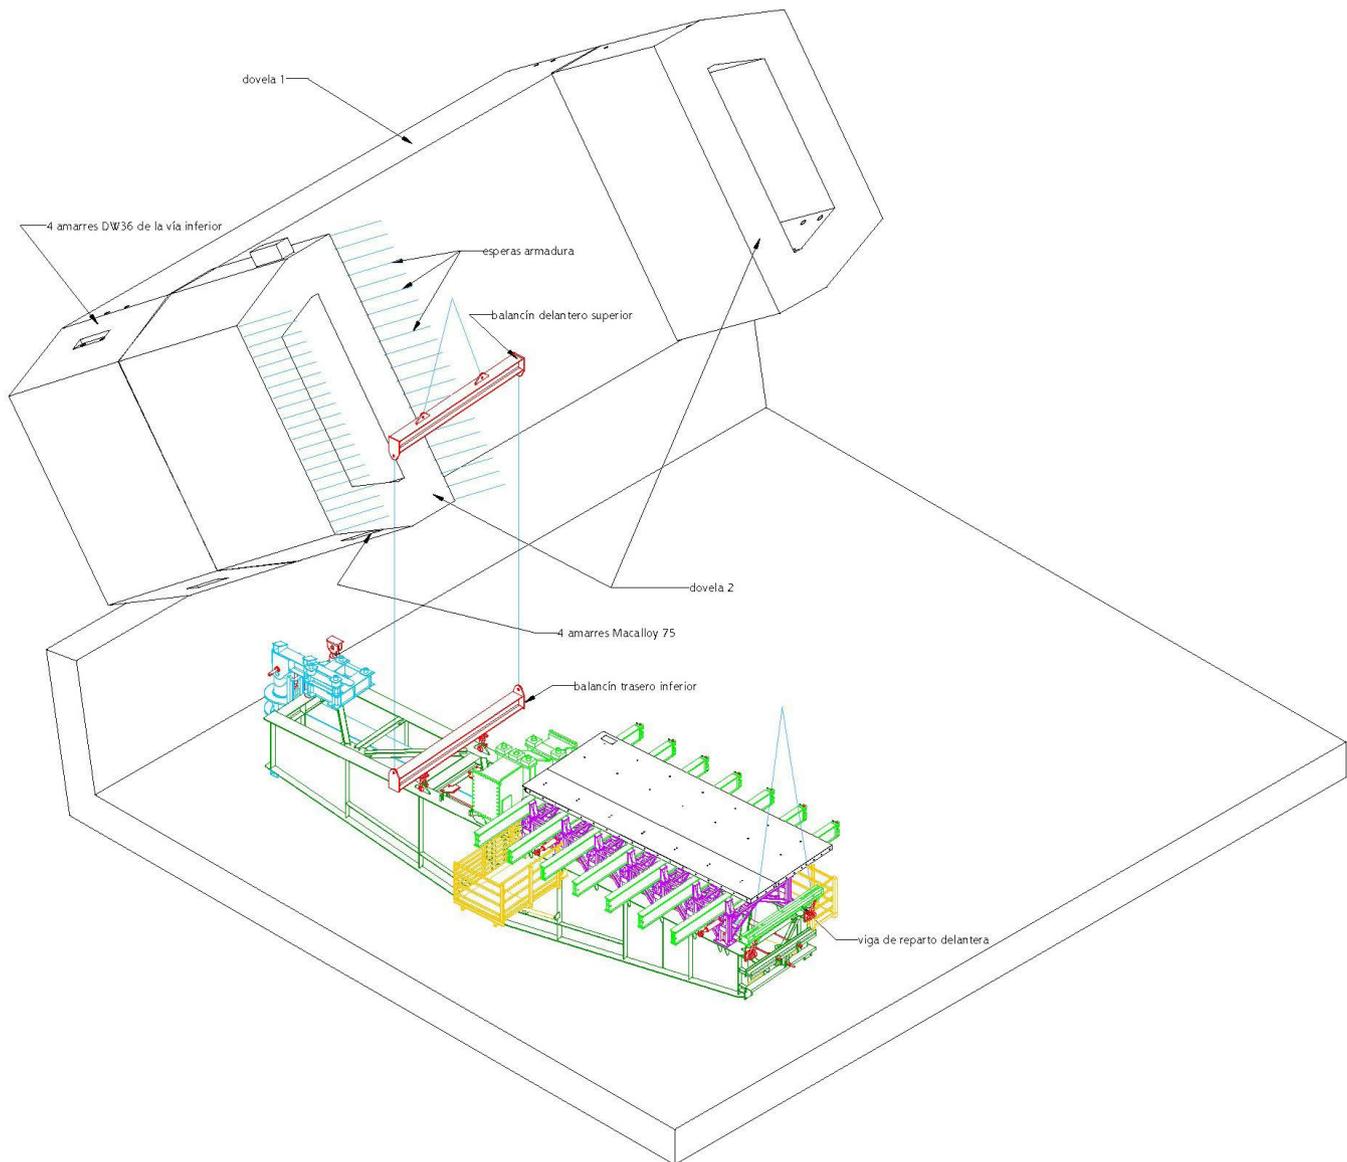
Izado de la viga principal de los carros de avance y anclaje en dovelas 1 y 2.
